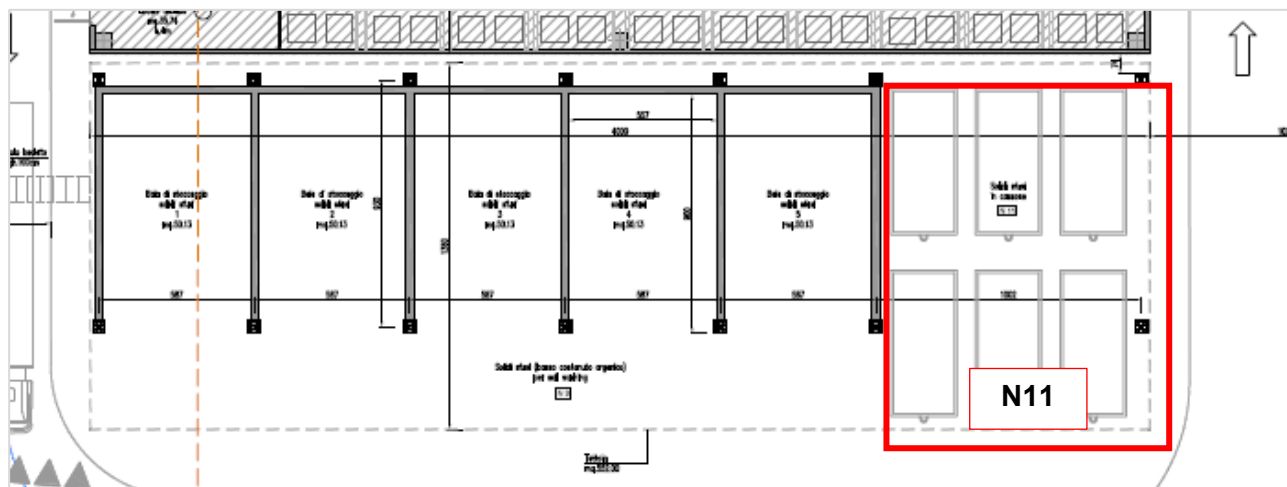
Dettaglio localizzazione Sezione N11 (stralcio elaborato CO 05 RA VA 01 D1 PL 68.00 - N3-N11 PIANTE)
